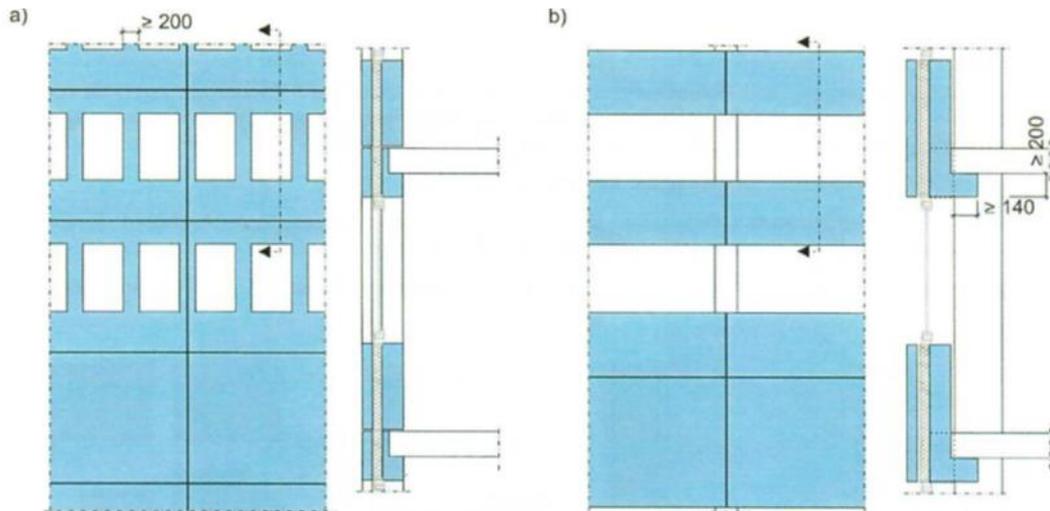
Schematische Ansichten und Fassadenschnitte bei zwei Tragwerksarten a) Fassade mit direkter Lastabtragung (hier: Lochfassade), b) Fassade mit Lastabtragung durch Stützen (hier: Bandfassade)
